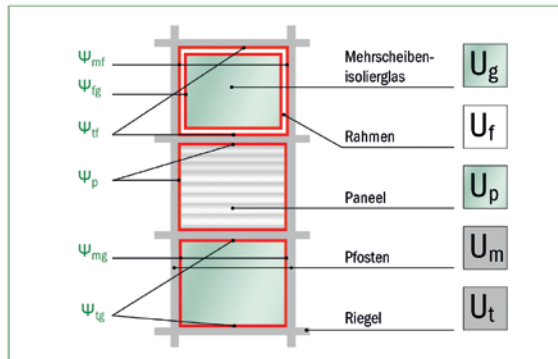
Musterfassadenelement gemäß EN ISO 12631 [3]
